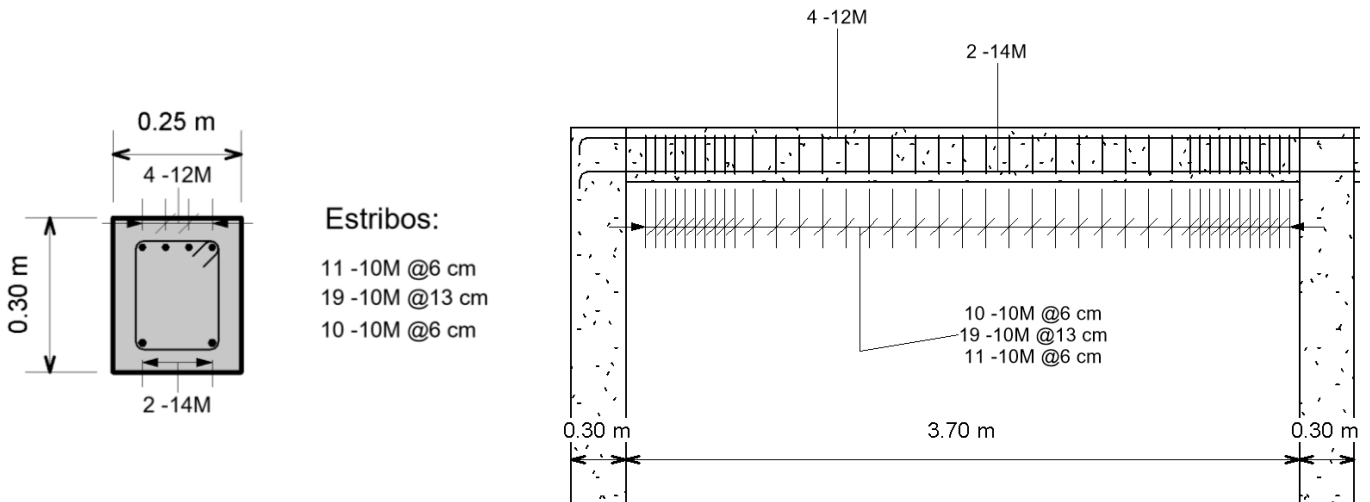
Dimensiones de la sección transversal y del refuerzo colocado en la viga 2 OMF del sistema de 6 pisos
